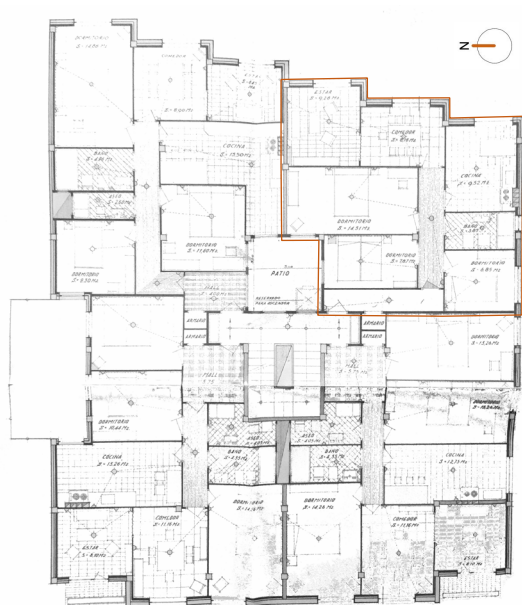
Planta tipo del inmueble situado en la Rúa Eugenio Kraff, nº11 (fotografía de autoría propia).
